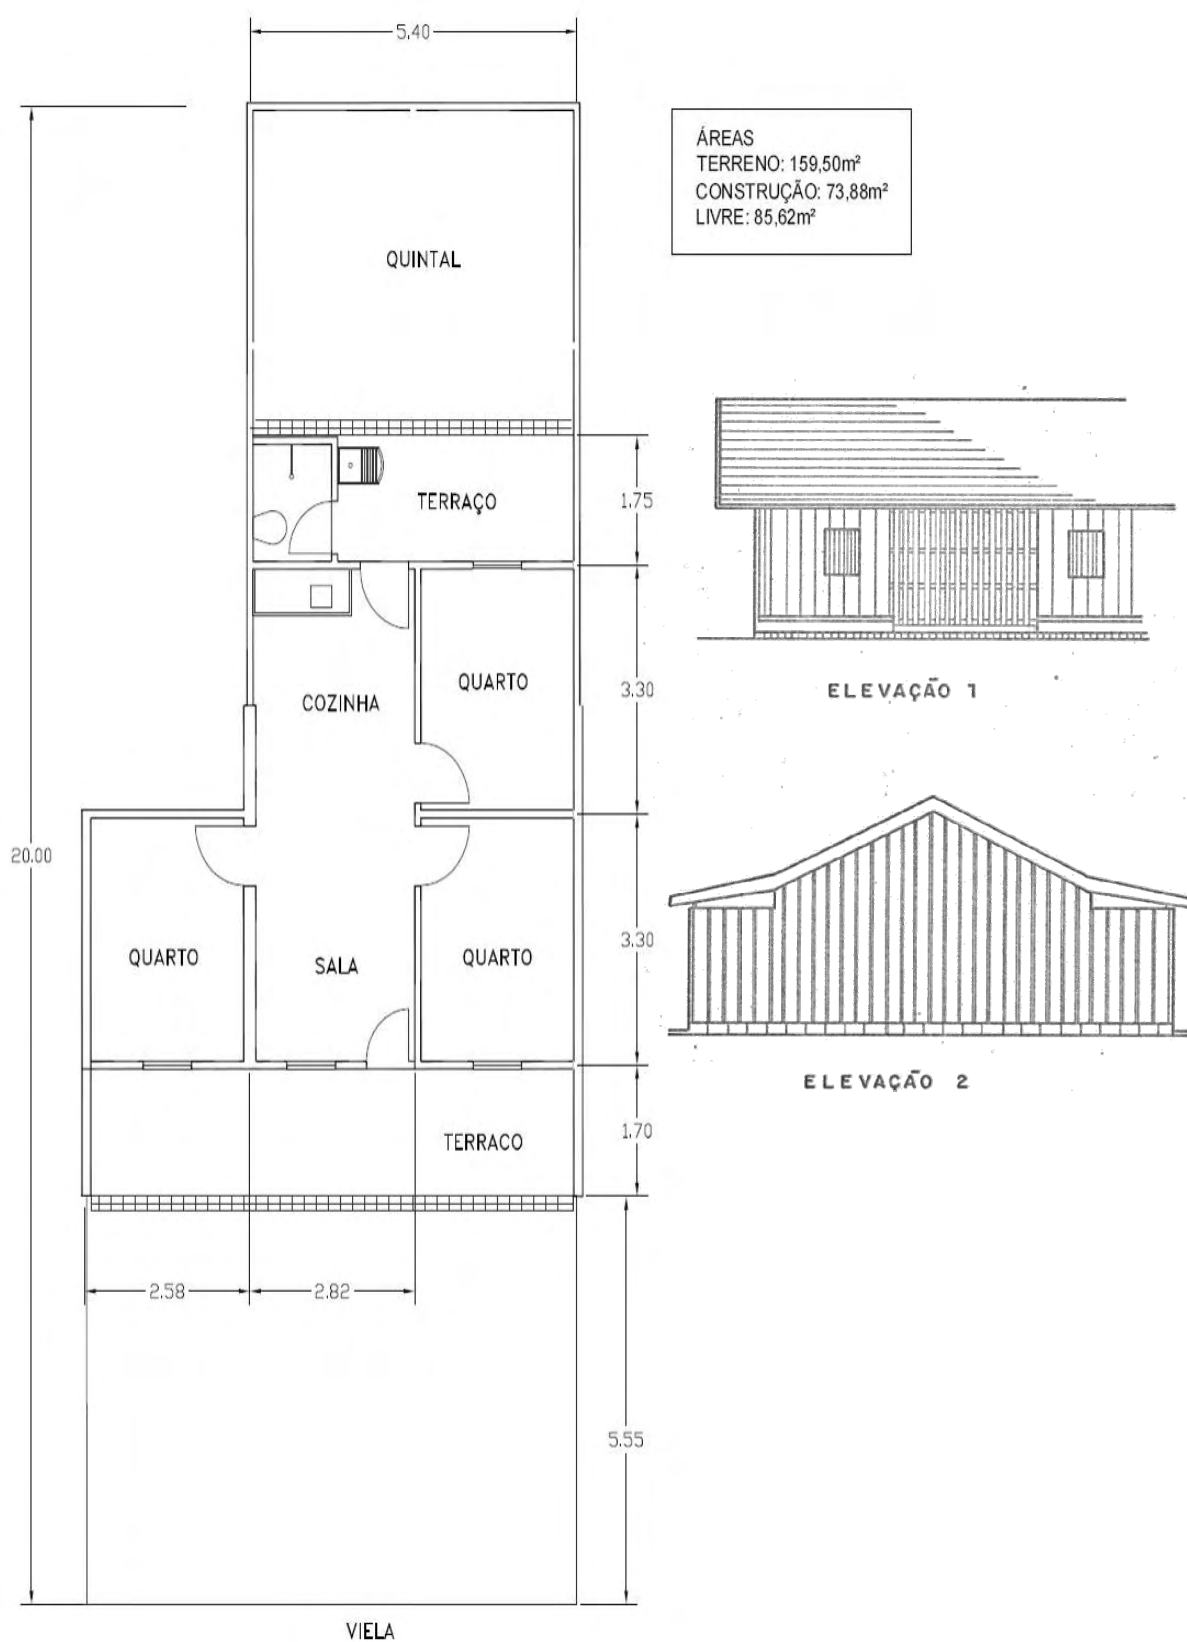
Figura F – Planta e elevação da casa tipo 2M-3Q (MANGE; KATO, 1963)
